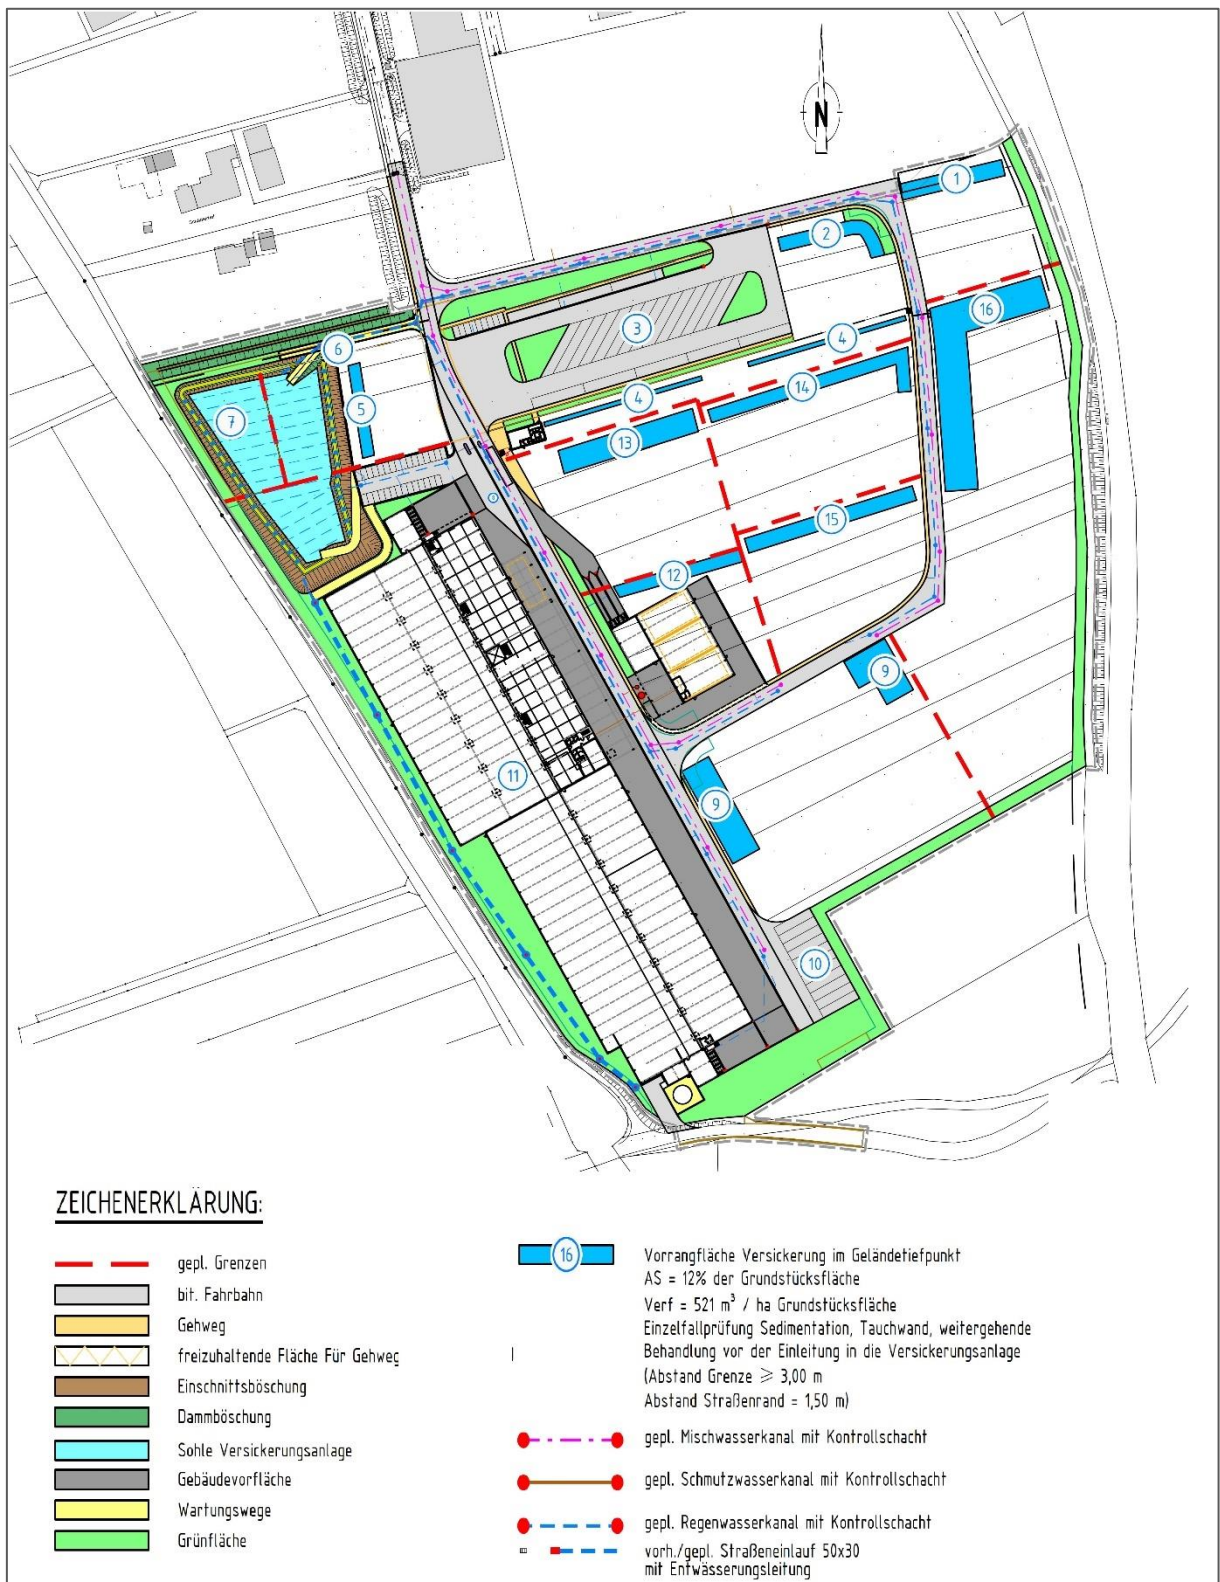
Rahmenplan Entwässerung, Quelle: Büro AGP, Bad Waldsee, 07.09.2023
